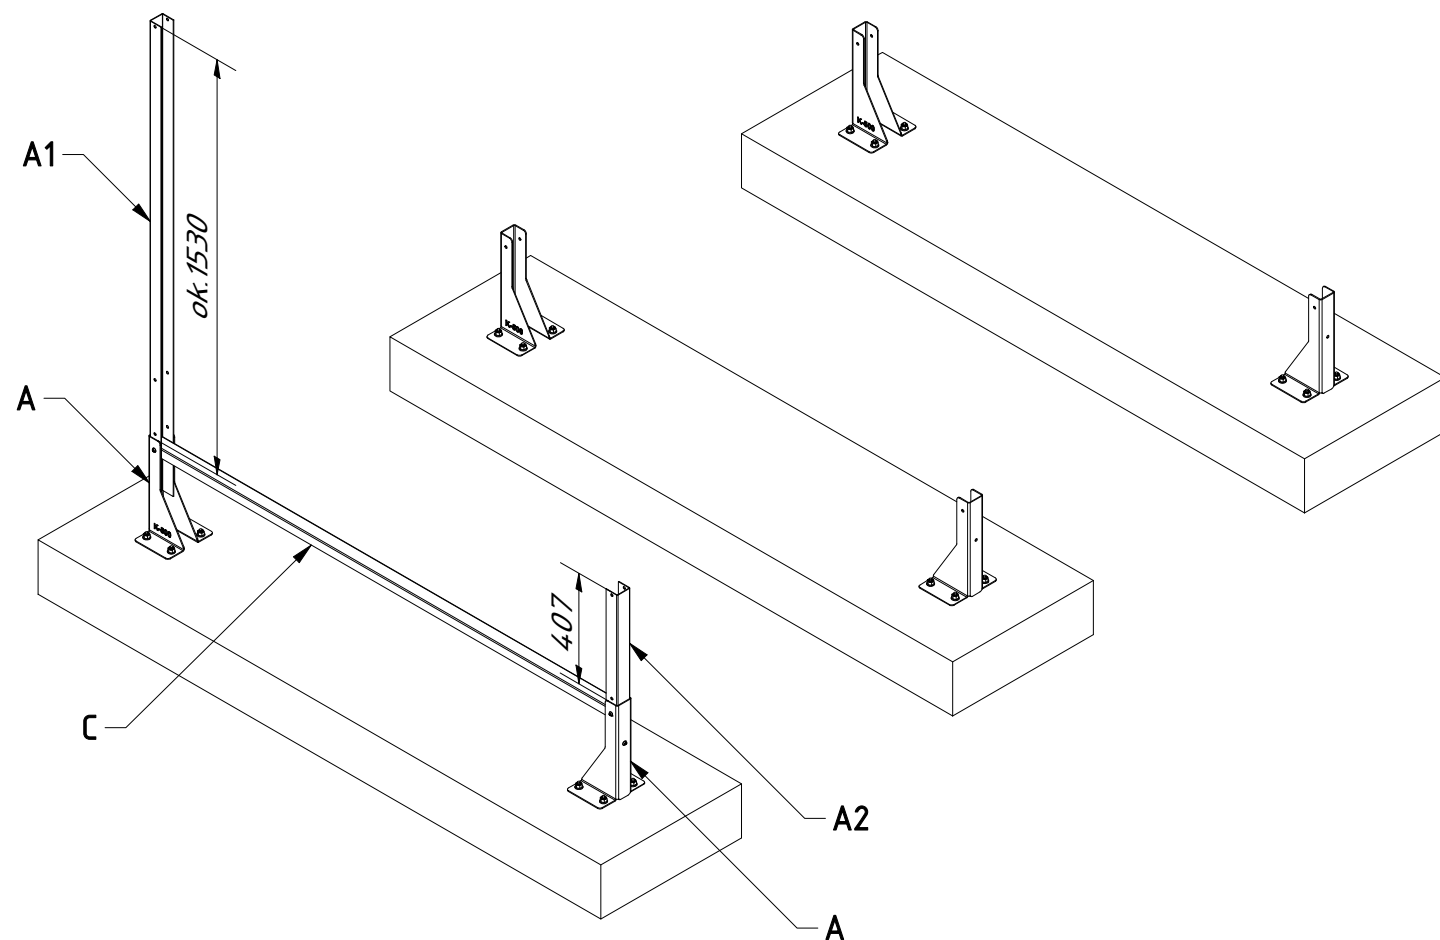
Montaż podstawy betonowej (A) na wylewce wykonanej w formie stóp betonowych
